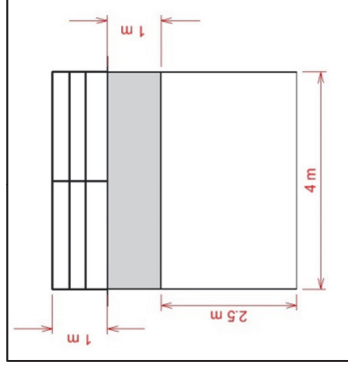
Estructura M12, culvert accés Vil·la Flora, sobre la riera Gavarra
